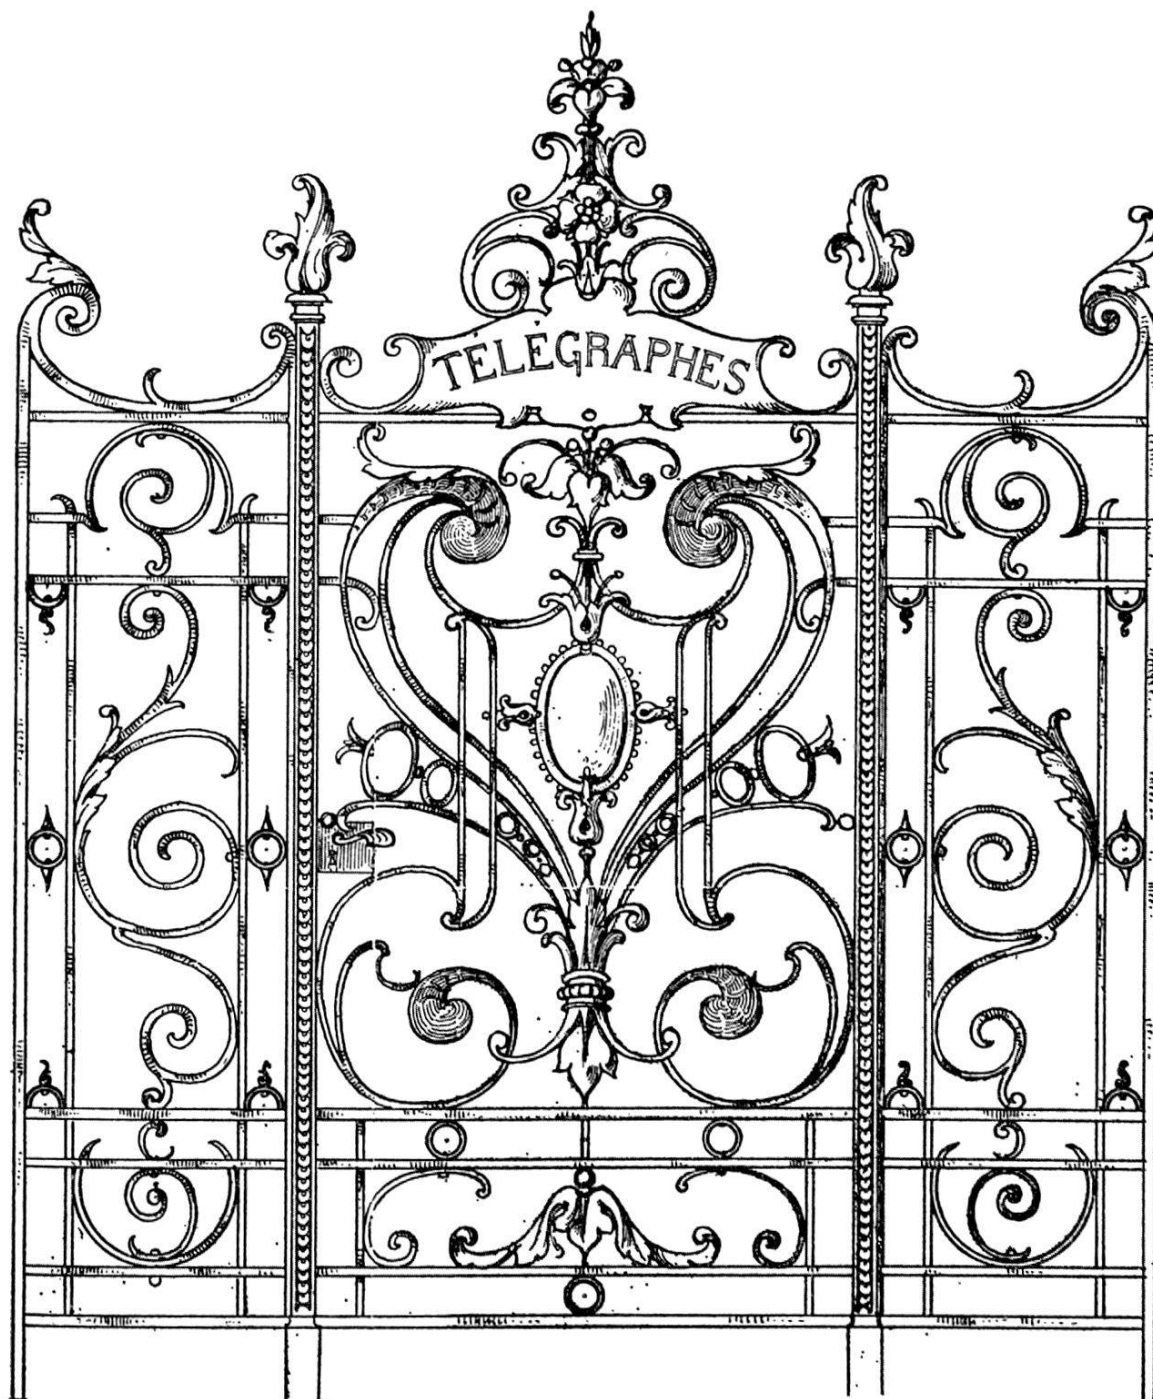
Gitter im Entrée Erdgeschoß, Originalplan Nr. 337
